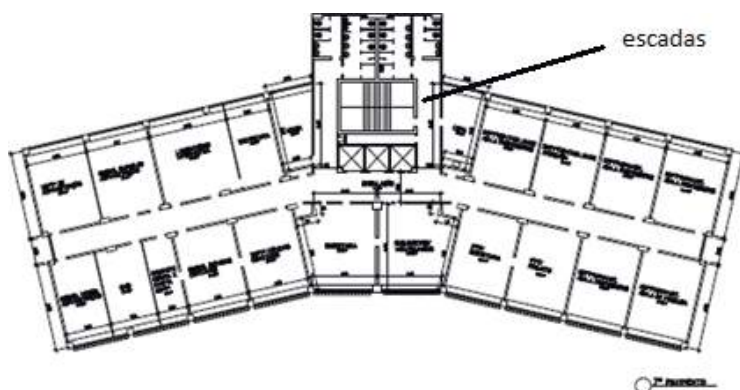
Planta baixa do 7o. pavimento. Fonte: Adaptado de SAEN
